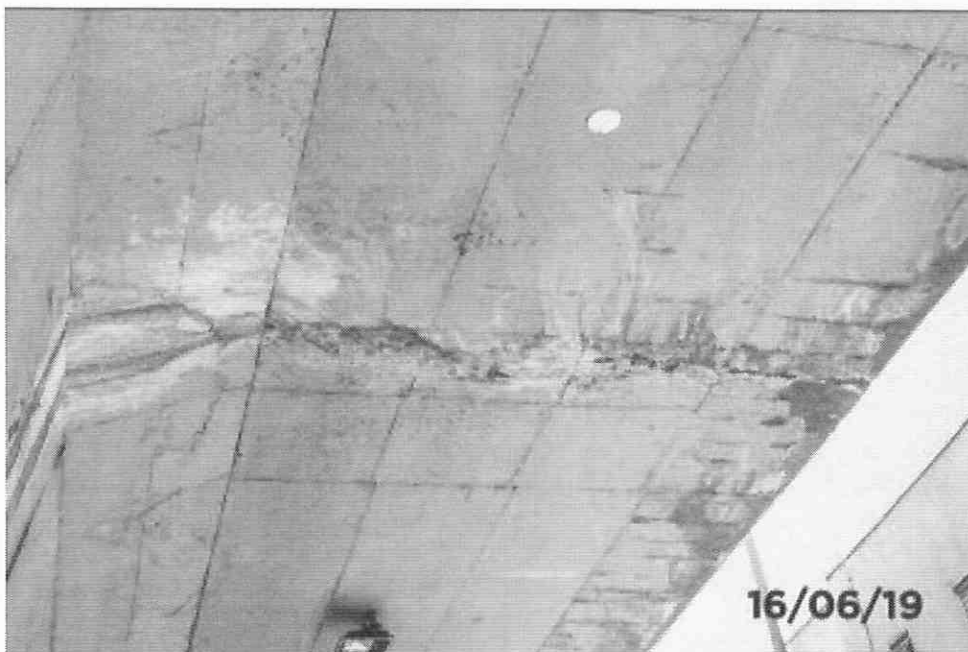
Detalhe na laje de trincas, eflorescência e armadura exposta.
